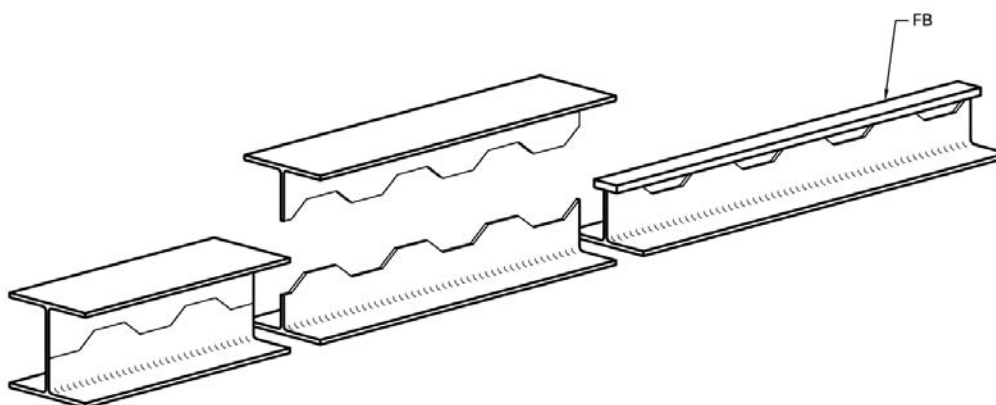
Viga “D” assimétrica – corte da viga (Fonte: Sistema Girder-Slab®)
